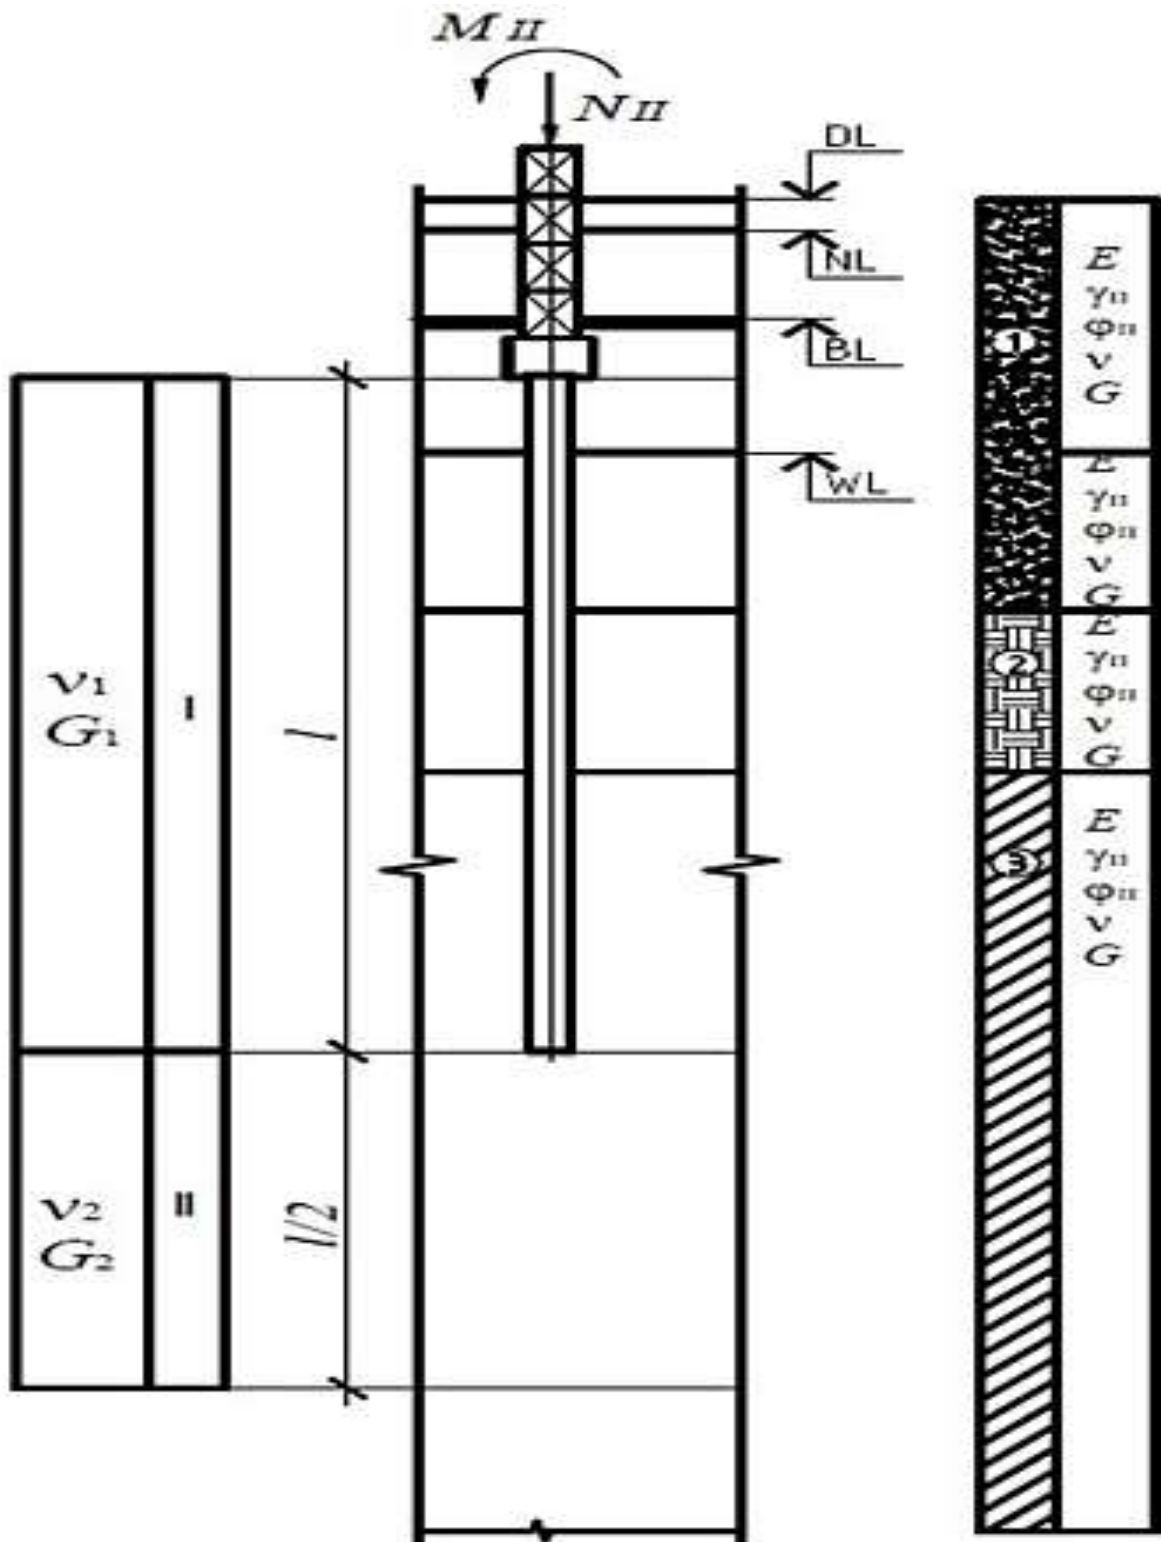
Схема к расчету свайного фундамента по деформациям (при низком ростверке).
